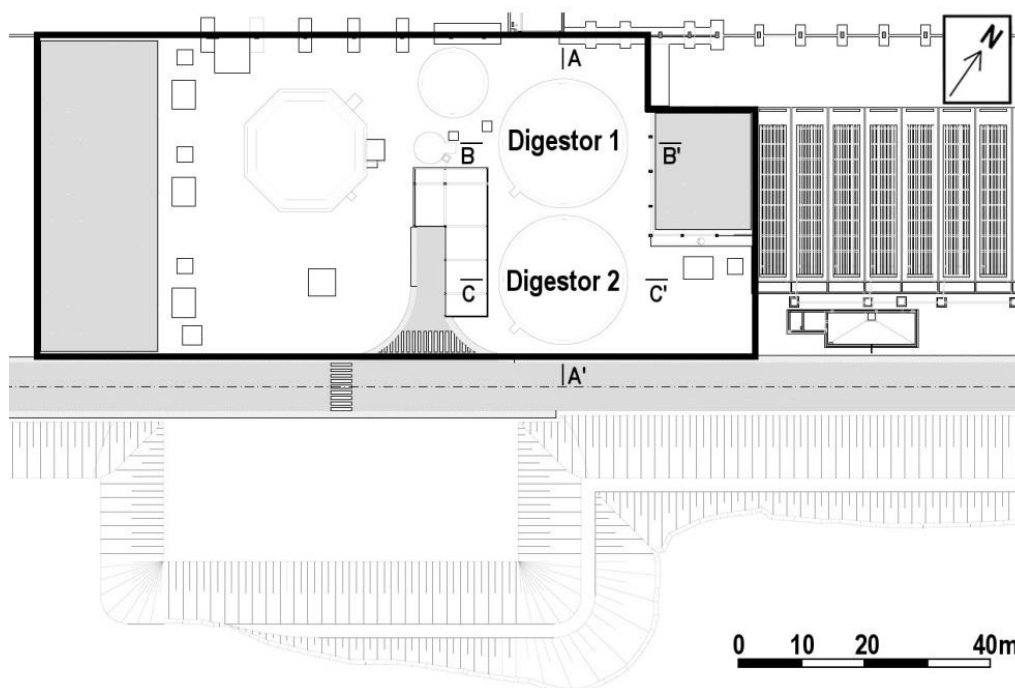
Planta da Zona 2 e estruturas anexas (adaptado de Edifer, 2011g)
